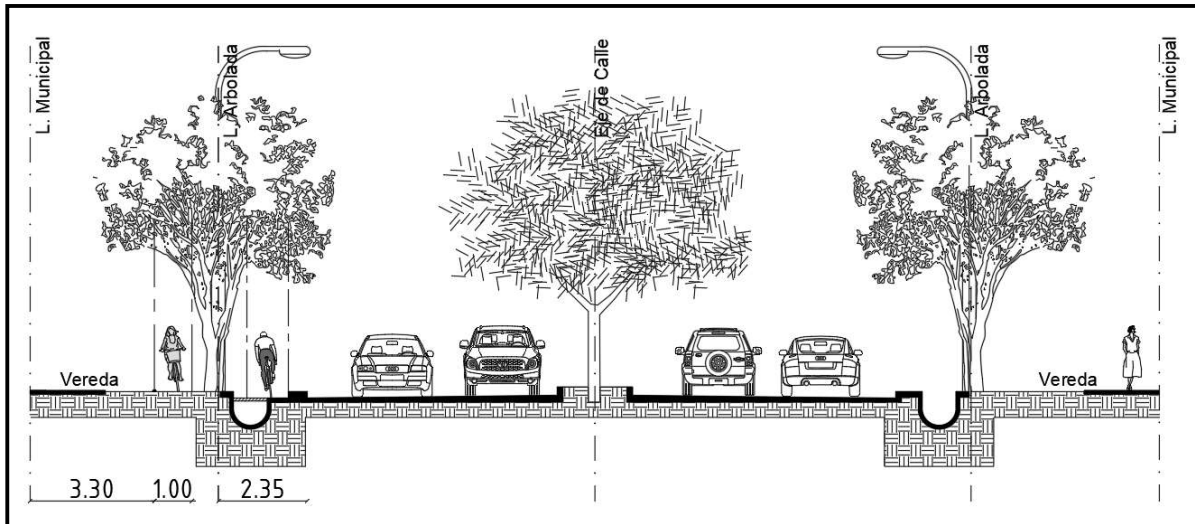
Perfil transversal en Av. Granaderos, sector con boulevard
